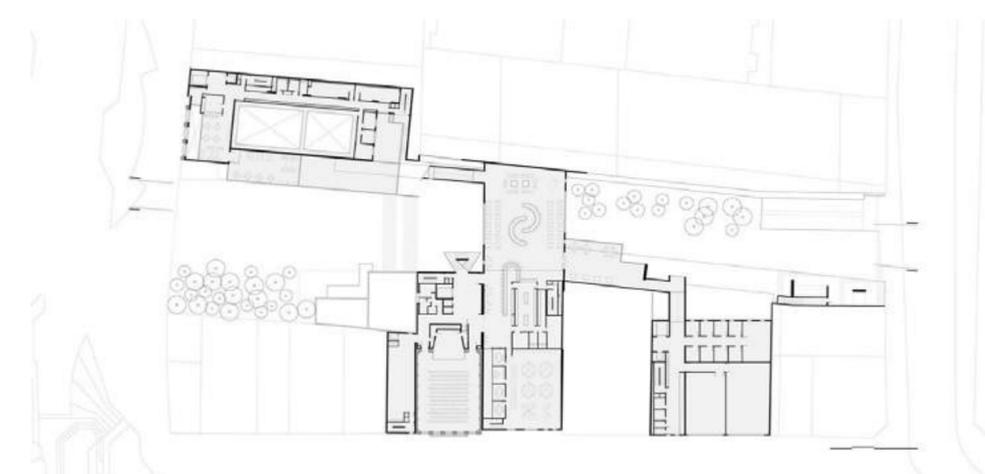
Planta Primeiro Pavimento/ Praça das Arte
